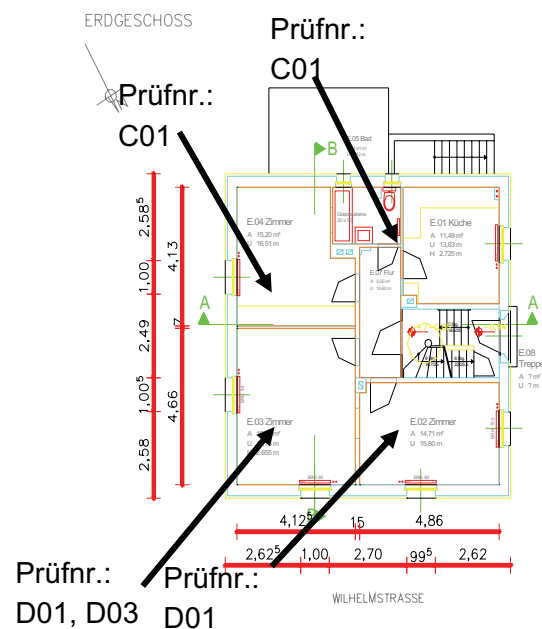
Grundrisszeichnung Haus Nr. 35, Erdgeschoss, mit Zuordnung der Prüfnummern zu den Räumen
